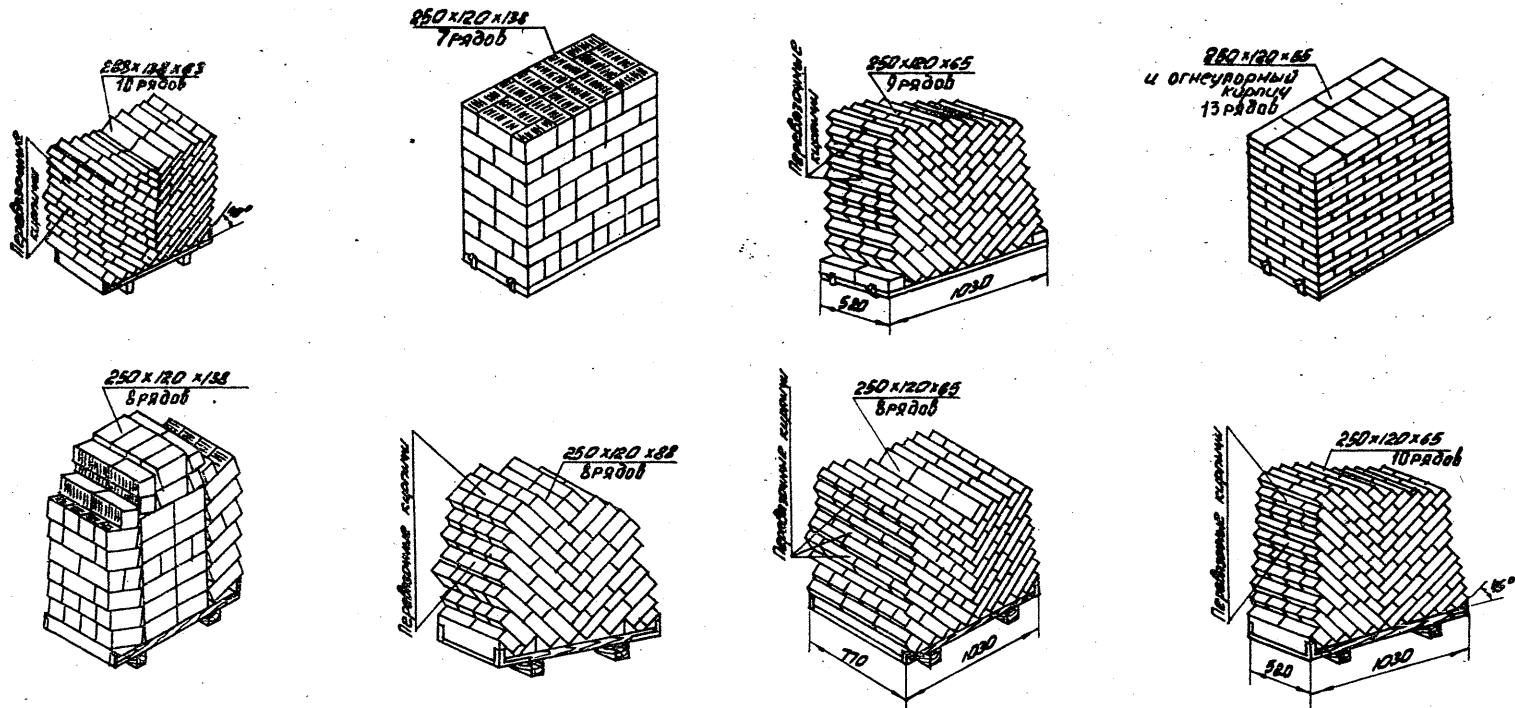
Укладка кирпича и стенных керамических камней на поддонах.
